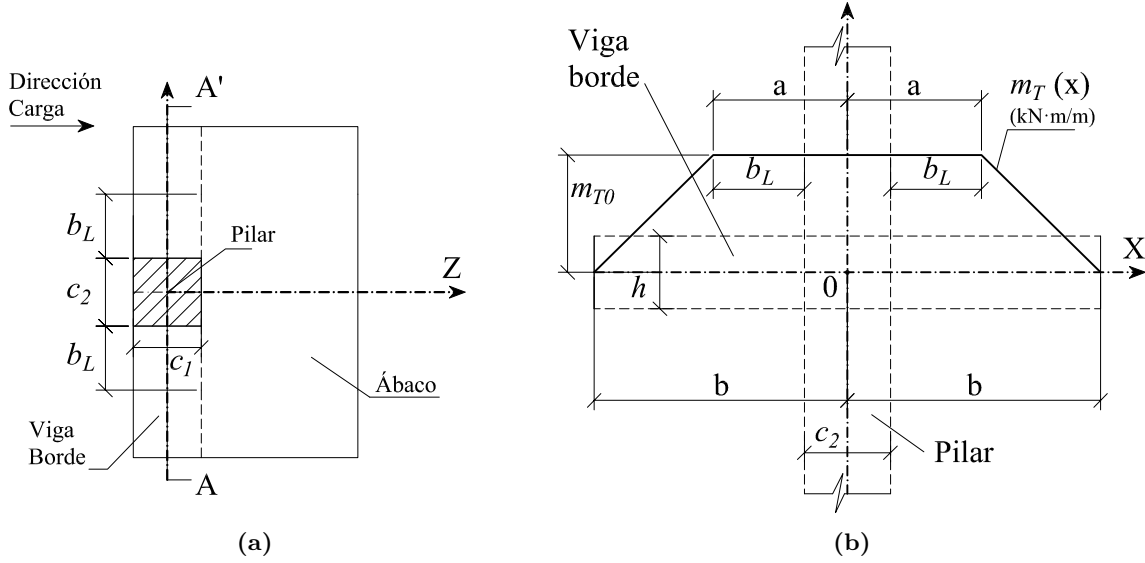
Zona ábaco-pilar de la conexión exterior: (a) Planta , (b) Ley de m_T en sección longitudinal (A-A') viga de borde
